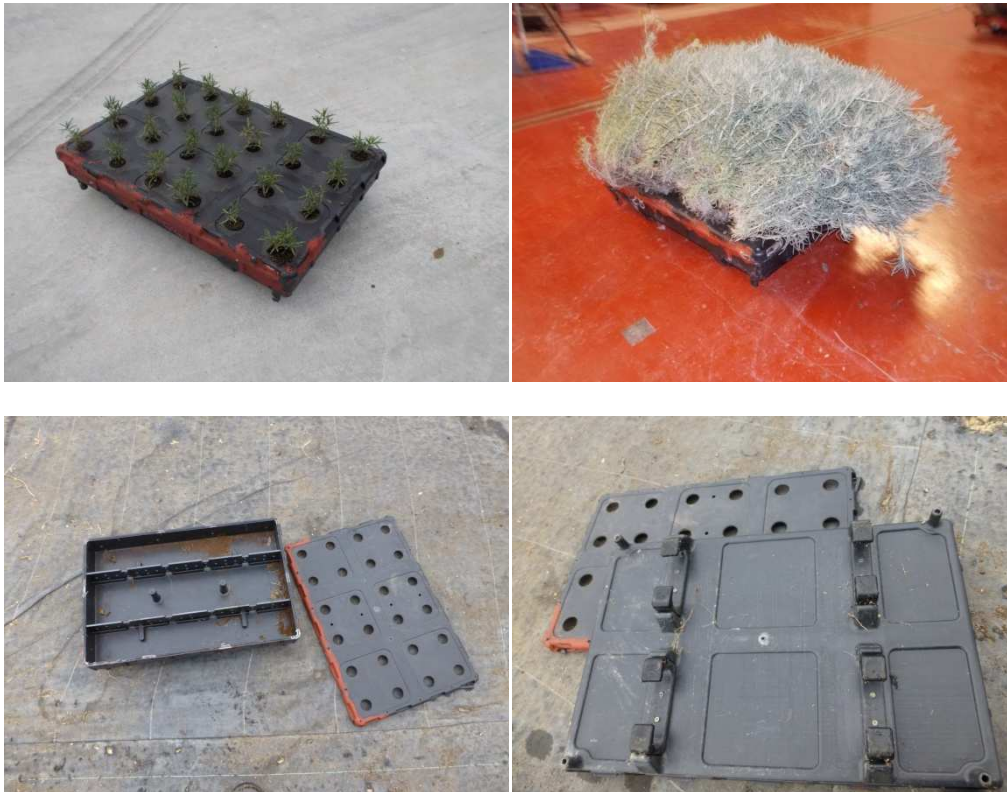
11.Detalle del modulo vegetal utilizado (a) con la plantas recién trasplantadas, (b) módulos con las plantas completamente desarrolladas, (c) detalle del interior de los módulos (d) detalle posterior del modulo con el gancho de sujeción a la estructura de anclaje
